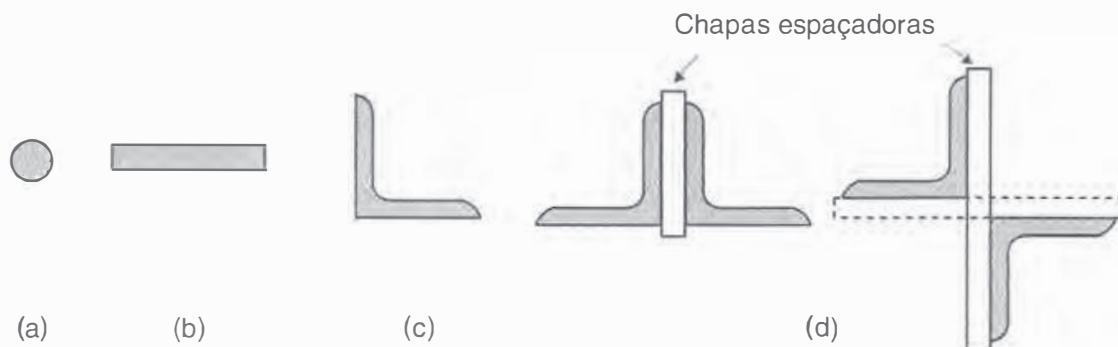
Tipos de perfis utilizados em peças tracionadas: (a) barra redonda; (b) barra chata; (c) perfil laminado simples (cantoneira); (d) seções compostas de dois perfis laminados (dupla cantoneira com faces opostas ou cantoneiras opostas pelo vértice).
